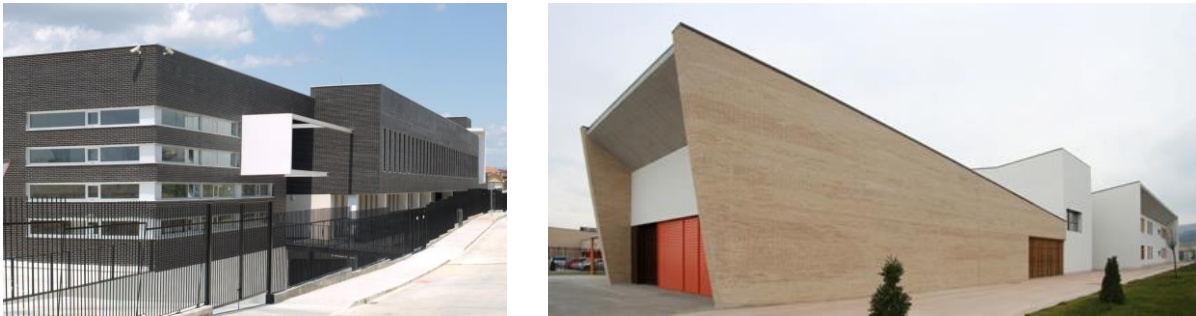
Ejemplos de obras realizadas con fachada autoportante de ladrillo cara vista STRUCTURA
